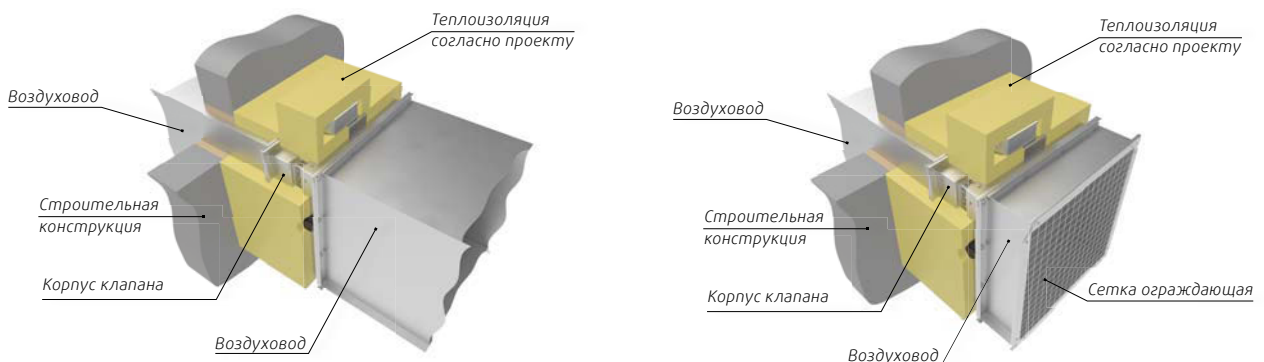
Схема монтажа канального клапана прямоугольного сечения с возможностью стеновой заделки
